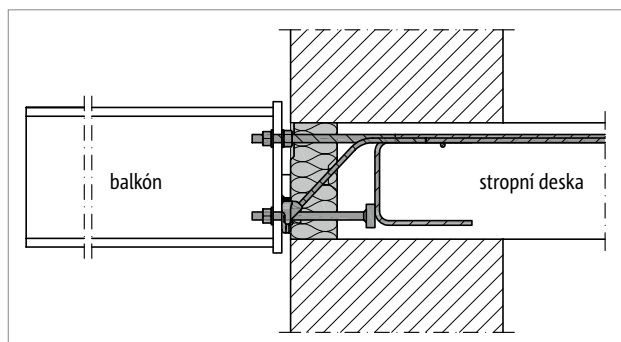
Schöck Isokorb® T typ SKP-WU-M1: Atypická konstrukce pro napojení na stěnu u prvků s třídami únosnosti ve smyku -V1 nebo -V2 pro tloušťku stěny od 200 mm
